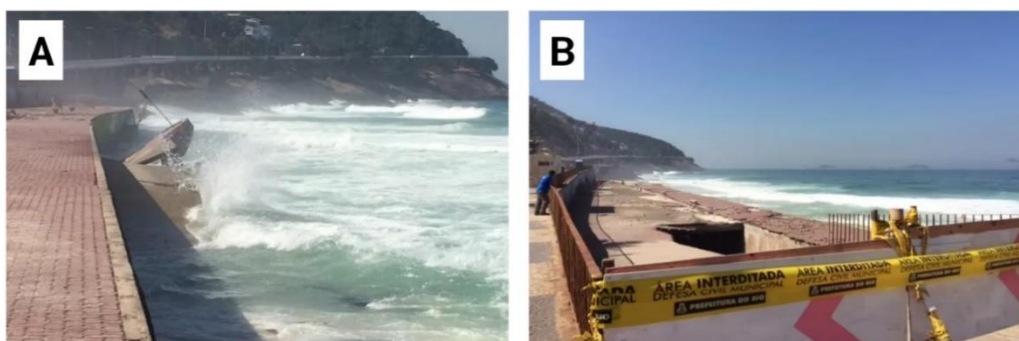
(A) Ondas atingindo rampa de acesso que ficava conectada à estrutura da laje.; (B) Buraco na estrutura da laje onde o projeto Sanca Sport Park foi idealizado. Fonte: G1, 2016.
